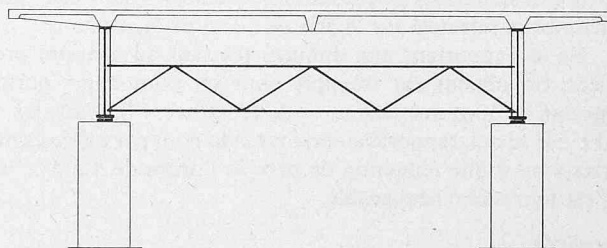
Pont avec un tablier à nervures appuyé sur deux poutres
